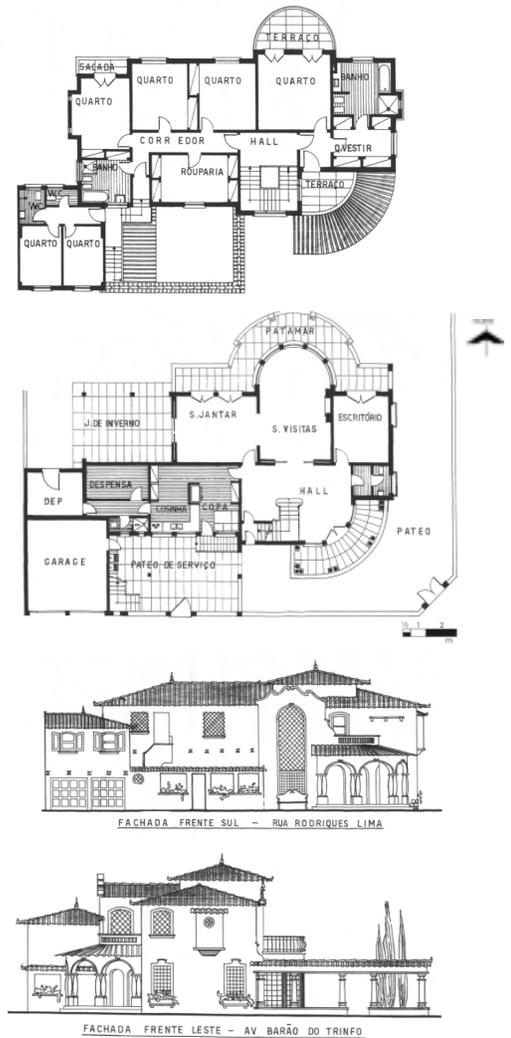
Casa Paulo Passos (1956), de Edmundo Bruno. Plantas baixas térreo, superior e Fachadas sul e leste.
